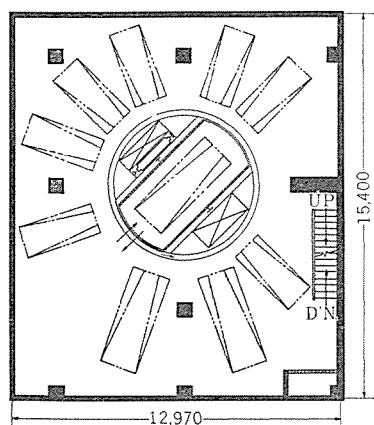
中川ビル駐車場10階平面図(旋回エレベータ式)
